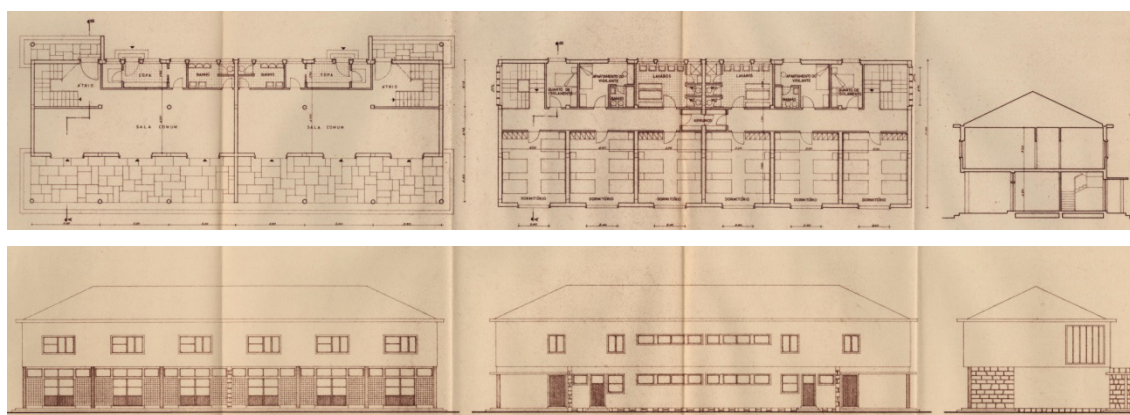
Plantas, corte e alçados de Bloco de Dormitórios do Instituto de Surdos de Bencanta.
